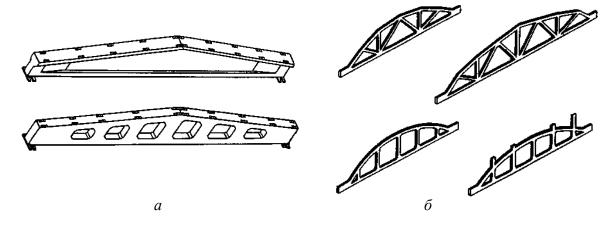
Конструкции покрытий: а – стропильные балки; б – стропильные фермы
